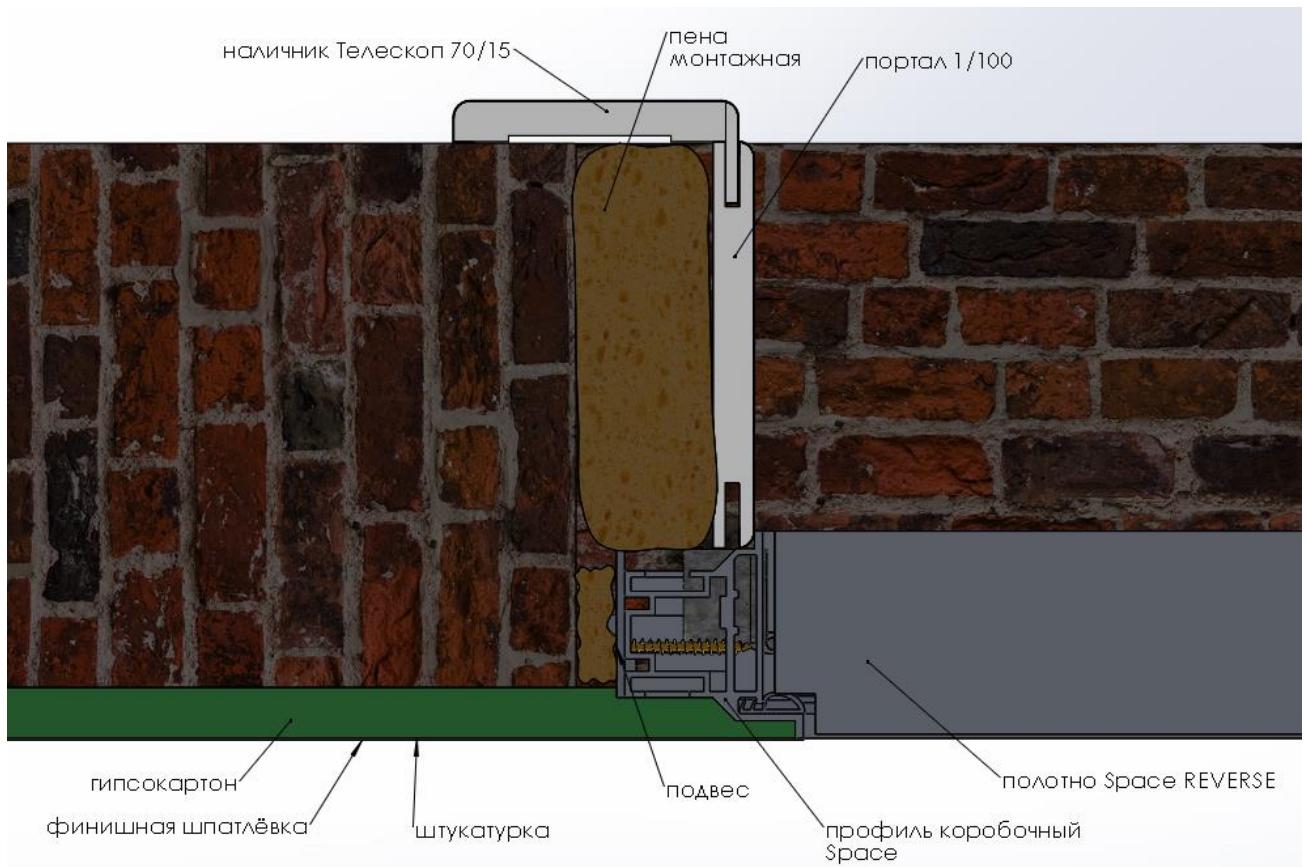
Схема установки дверного блока Space REVERSE с погонажными элементами
